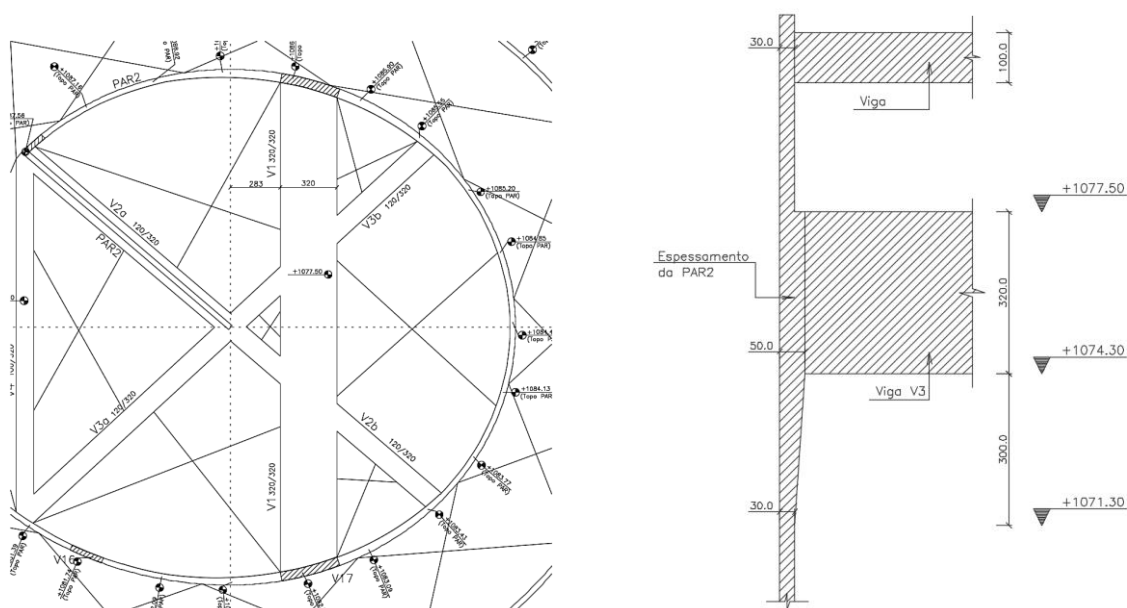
(a) Planta da grelha de vigas na cobertura onde se apoia a parede de topo da cobertura; (b) Espessamento das paredes laterais na zona de ligação às vigas da grelha.
